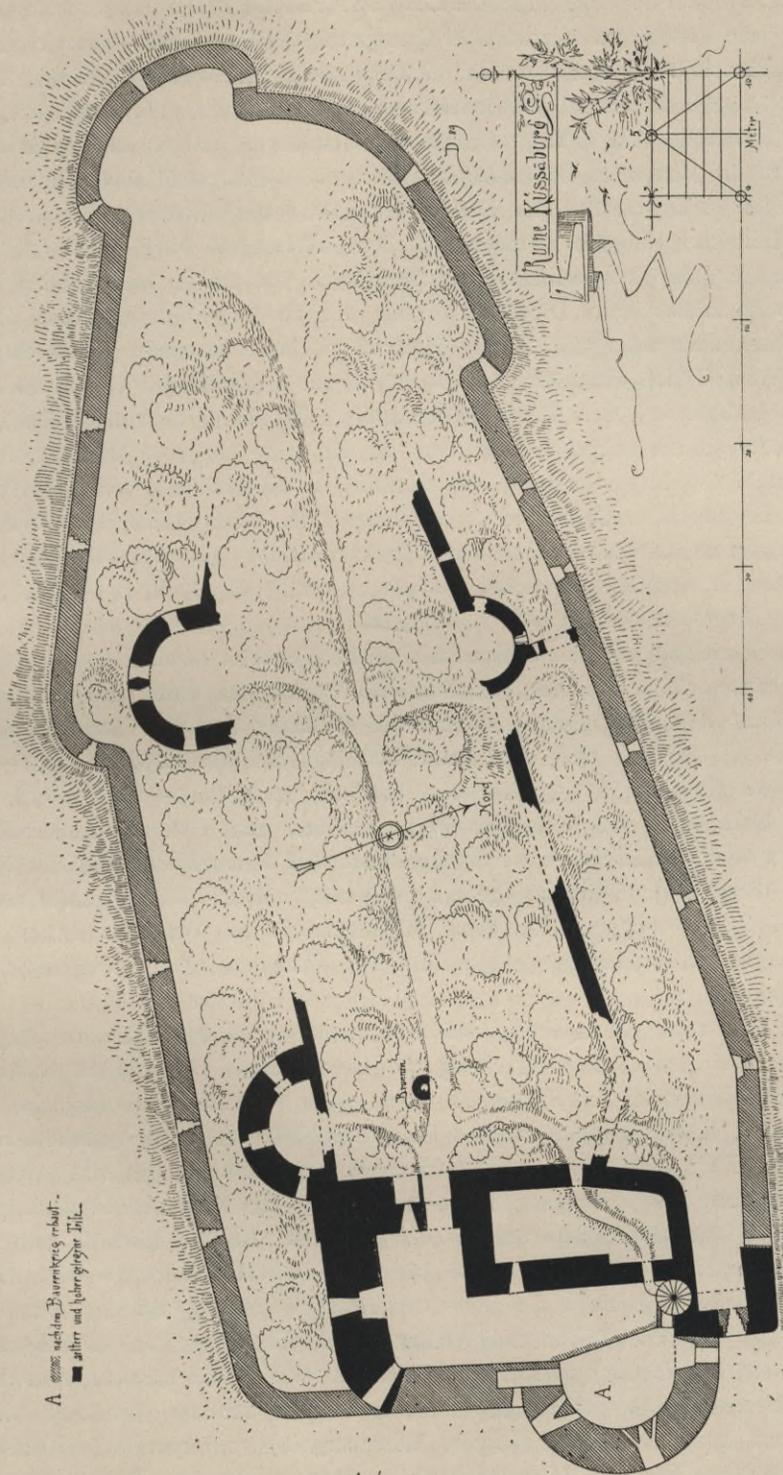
Küssaberg. Grundriss der Burgruine.
